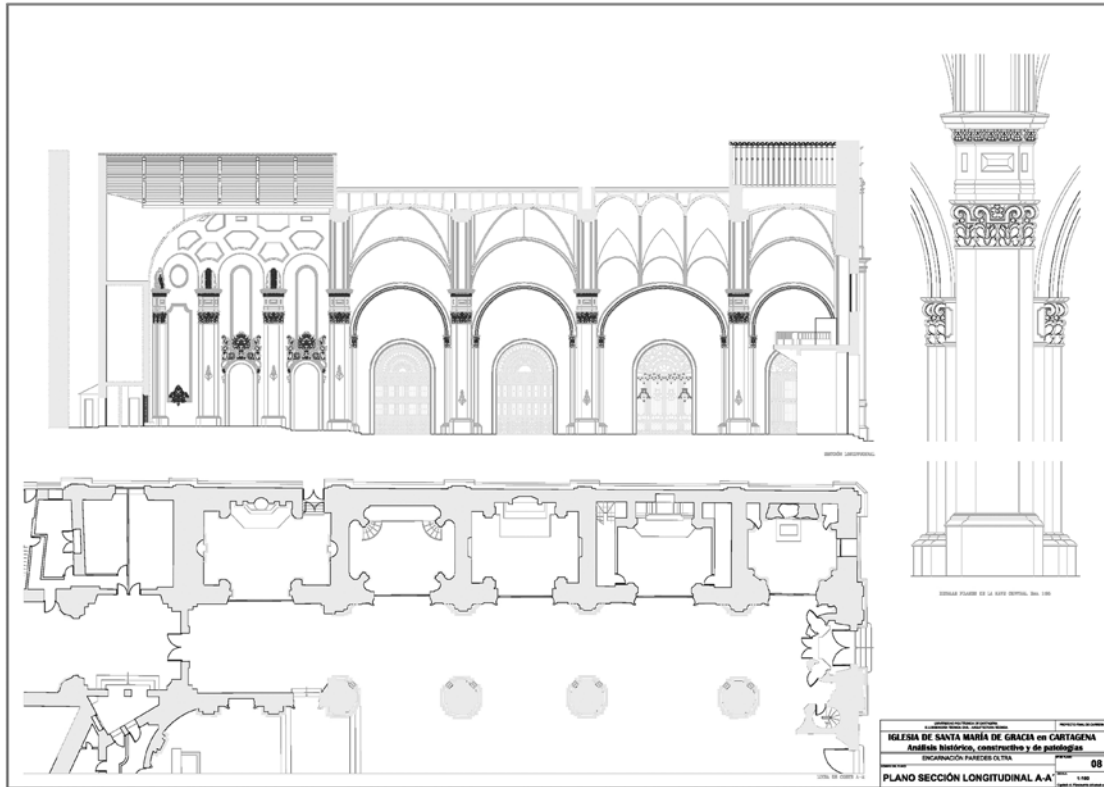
Plano de sección longitudinal y detalle de soporte de la nave central.
